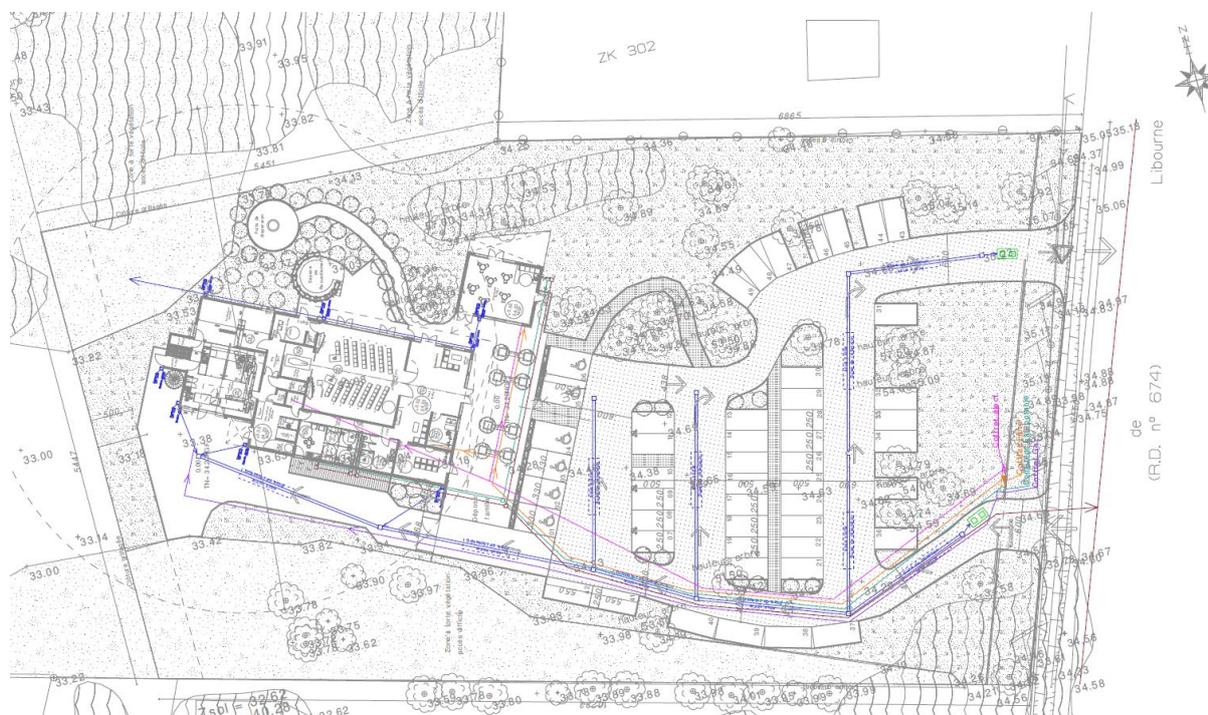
Plan de la gestion des eaux pluviales pour les surfaces imperméabilisées.
